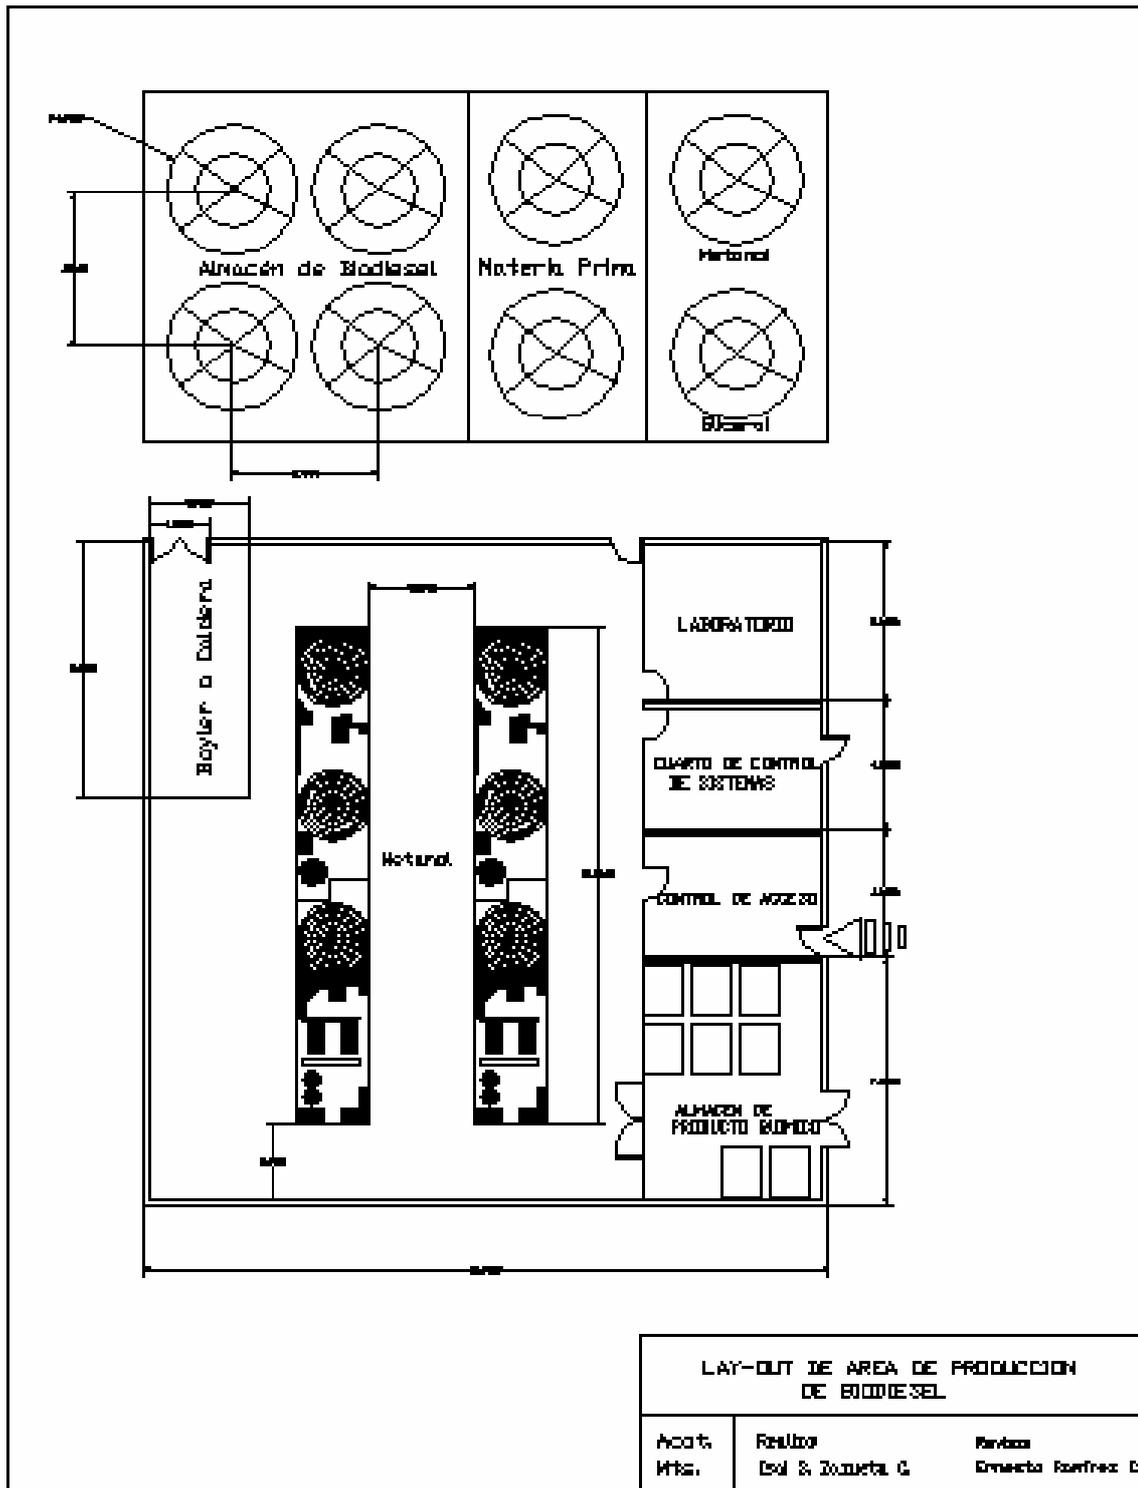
Layout de la planta procesadora de Biodiesel.
